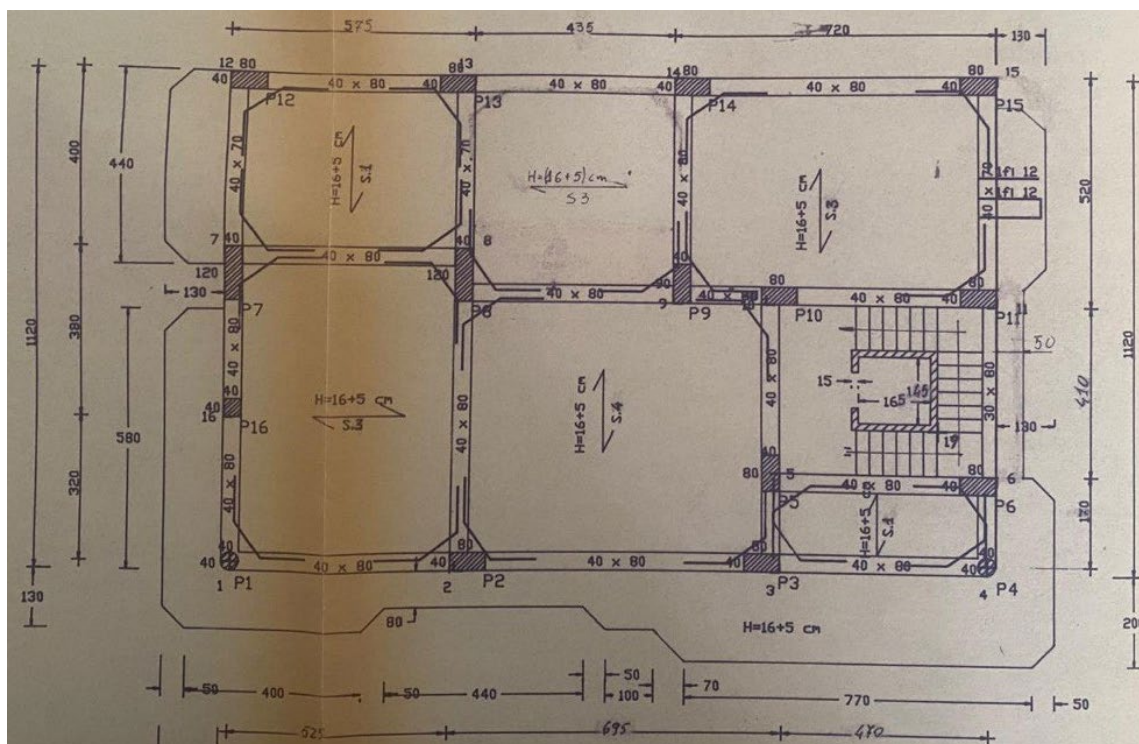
Carpenteria elevazione 2 edificio oggetto di studio
